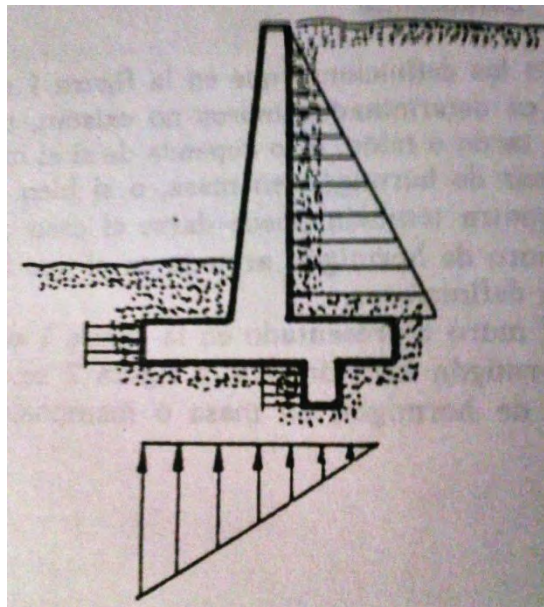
Acciones del terreno sobre un muro de concreto armado.
